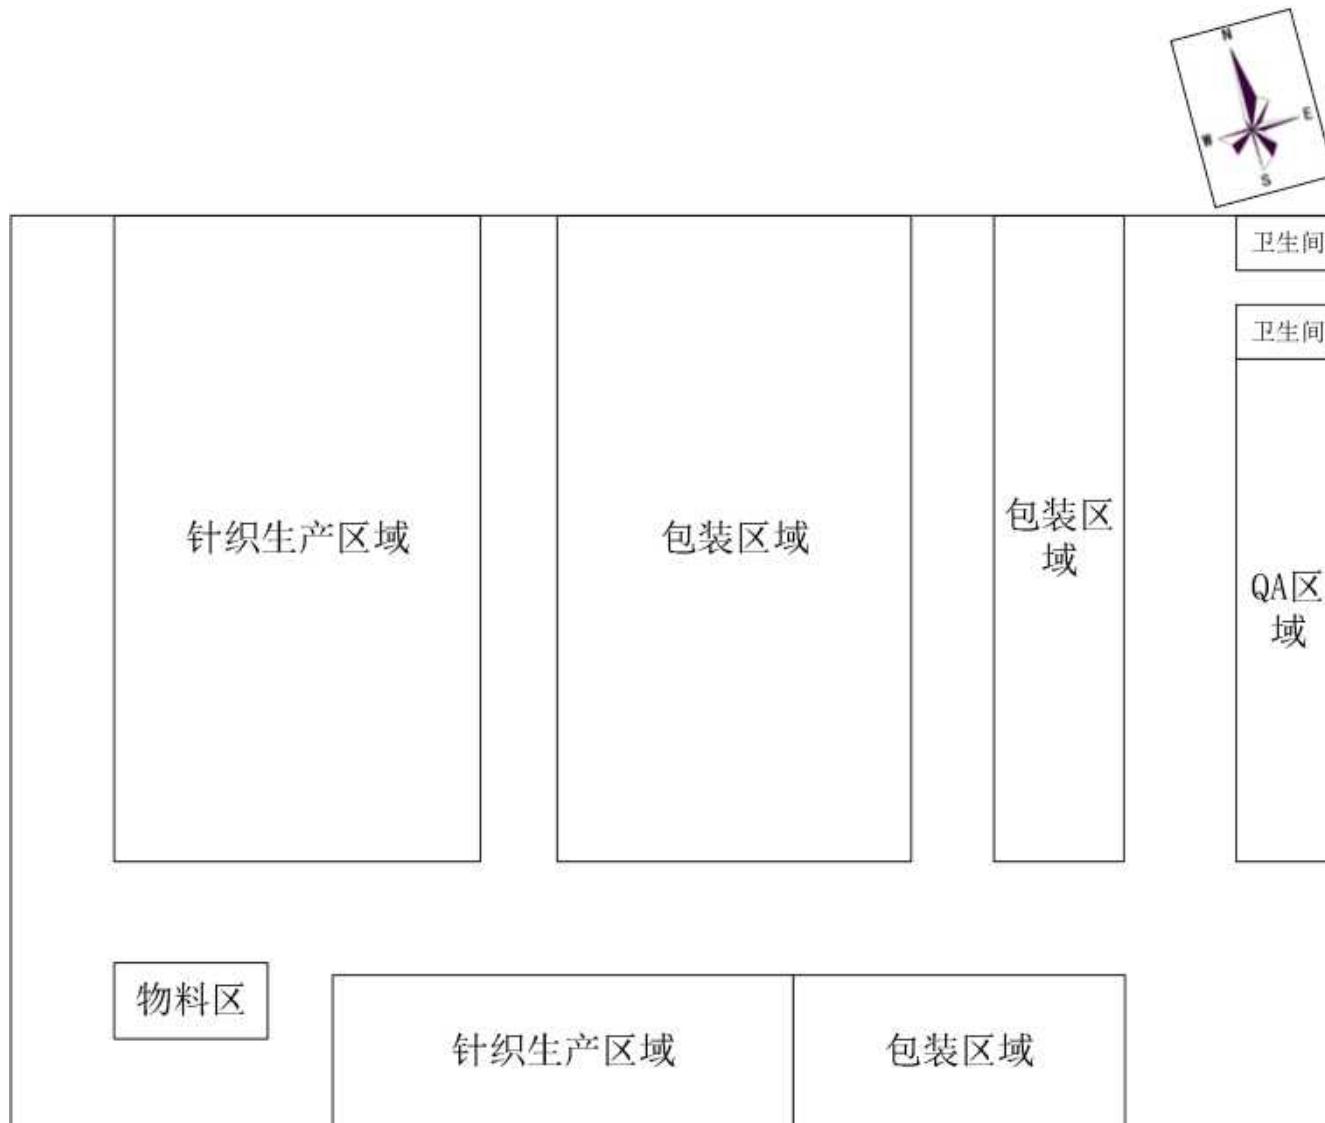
技改扩建后生产车间平面布置图（厂房 B 第三层）
